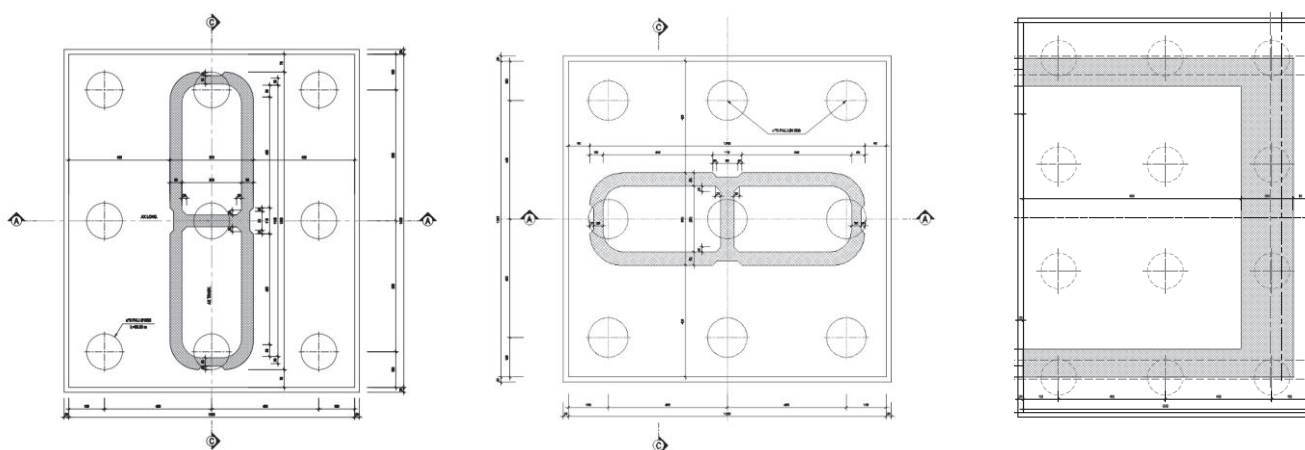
Pianta delle fondazioni delle pile P1-P2 a sinistra, delle pile P3-P15 e P19-P28 al centro, e delle spalle a destra
